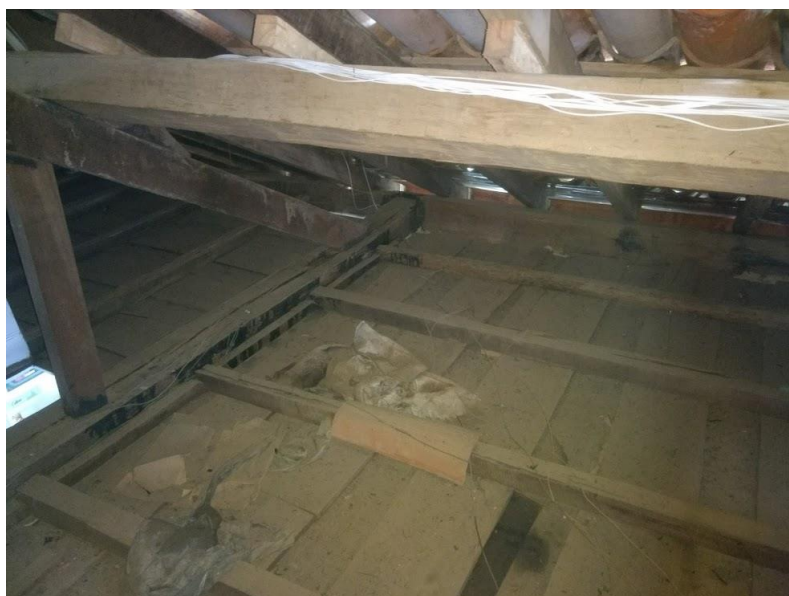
Detalhe do madeiramento deteriorado do telhado.
